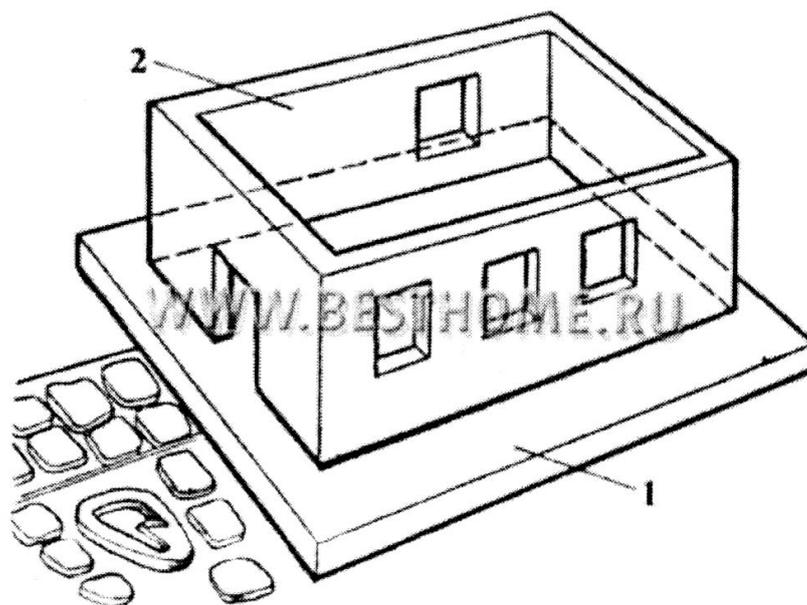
Размещение дома на целиковой бетонной незаглубленной плите:
